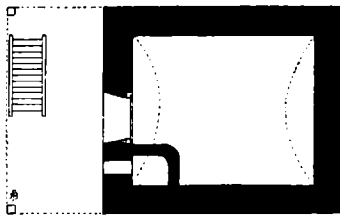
Grundriss des Erdgeschosses von Abb. 178.
